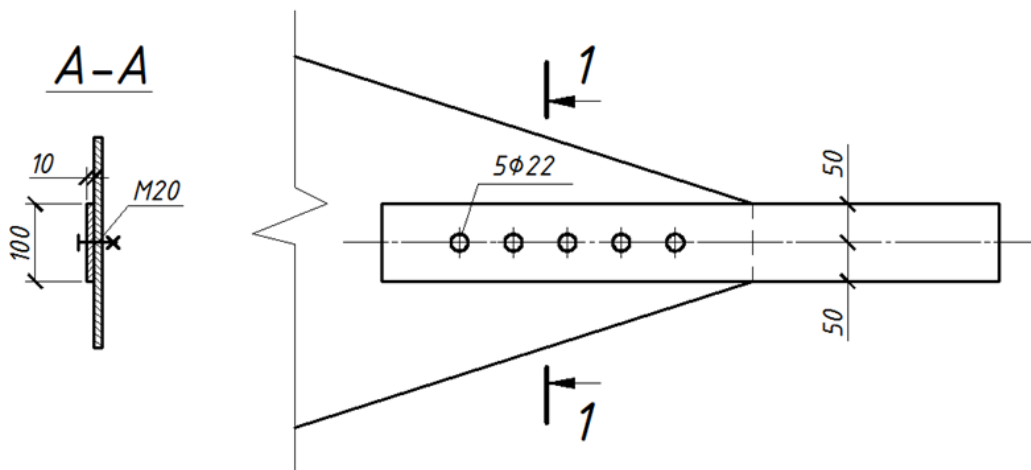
Болтовое соединение с рядовым расположением отверстий
